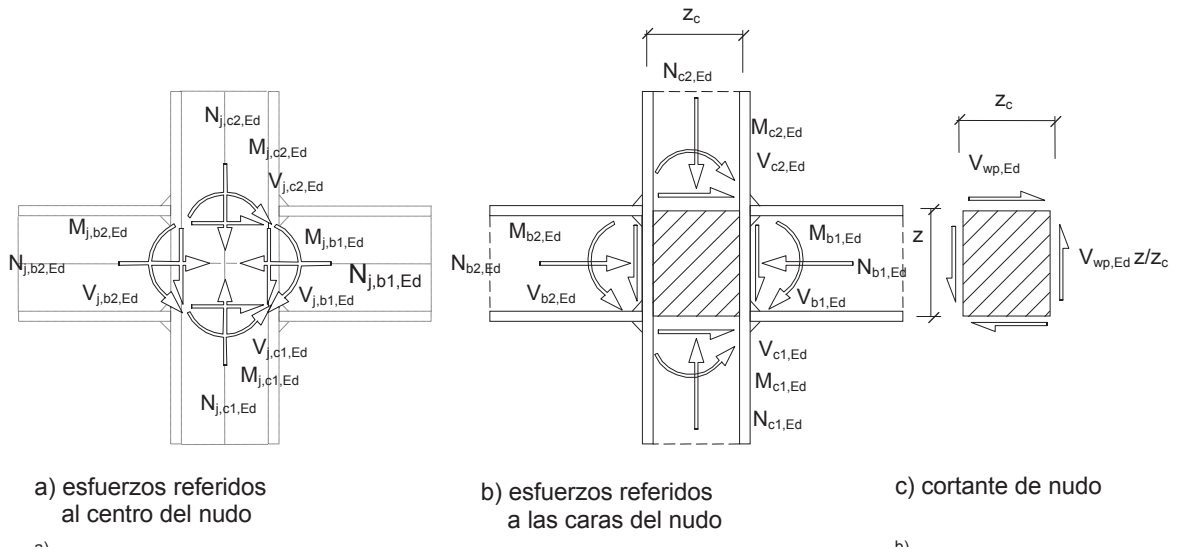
Unión (soldada o atornillada) y cortante de nudo
